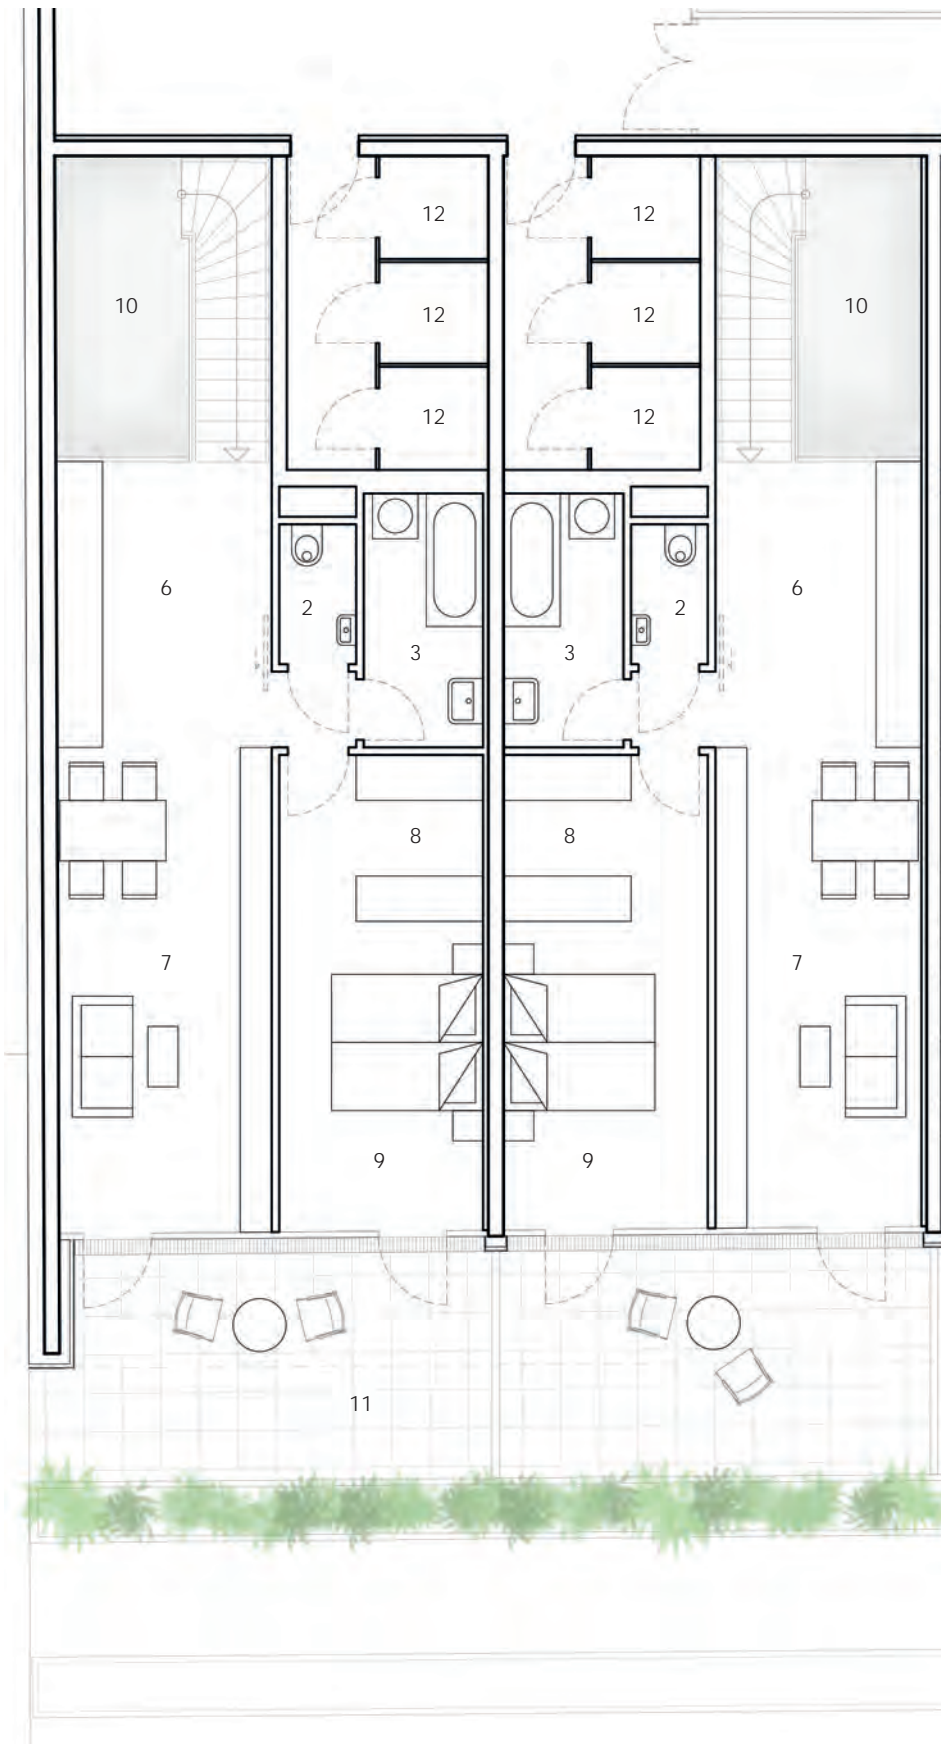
links: Grundriss 3. Obergeschoß Wohnung Typ C.
